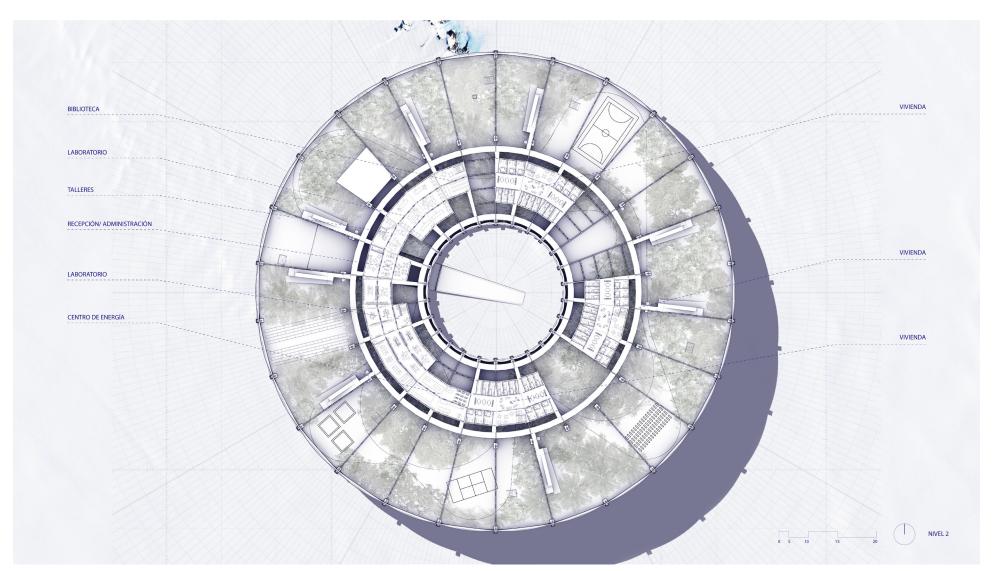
Planta nivel 2, Elaboración propia, 2021.
